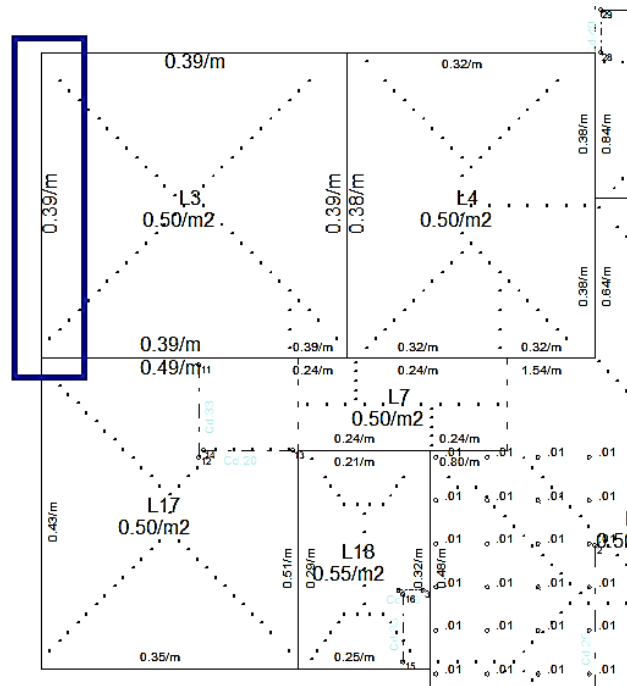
Distribuição das cargas da laje em tf/m, para o pavimento tipo.
